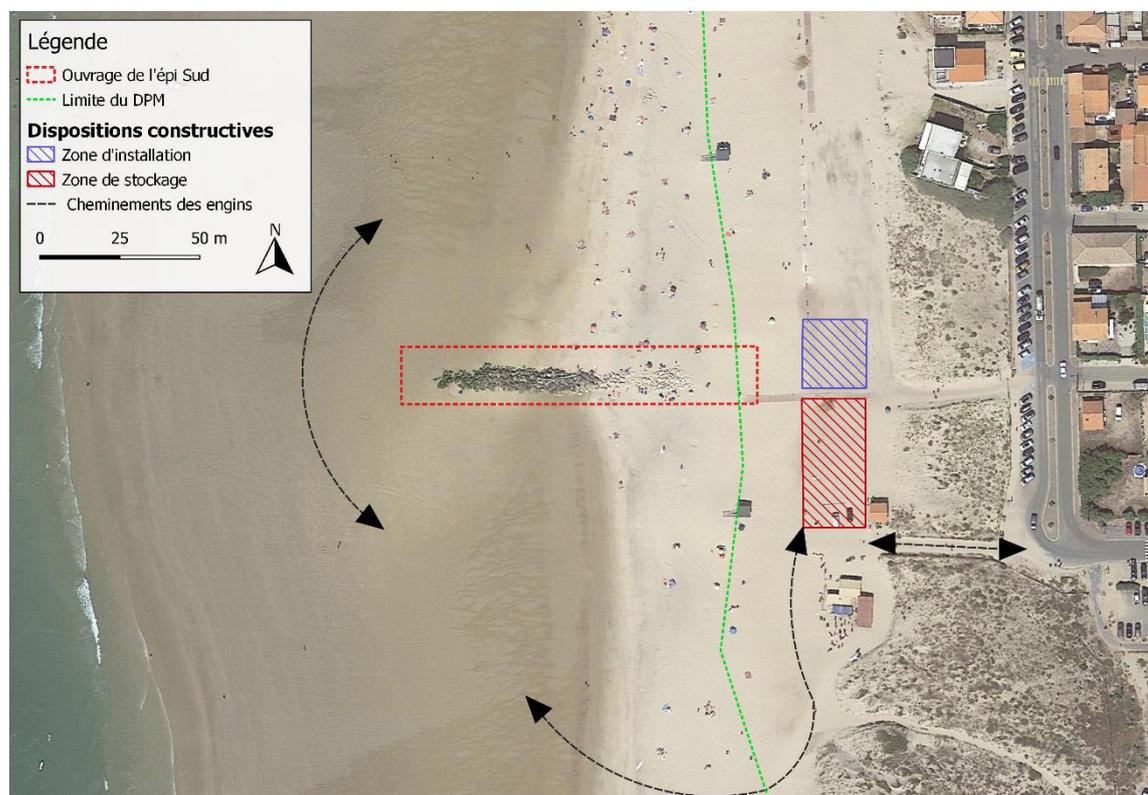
Localisation des installations de chantier dans le cadre des travaux d'allongement de l'épi Sud (Fond de plan : Google Satellite, 2021).
